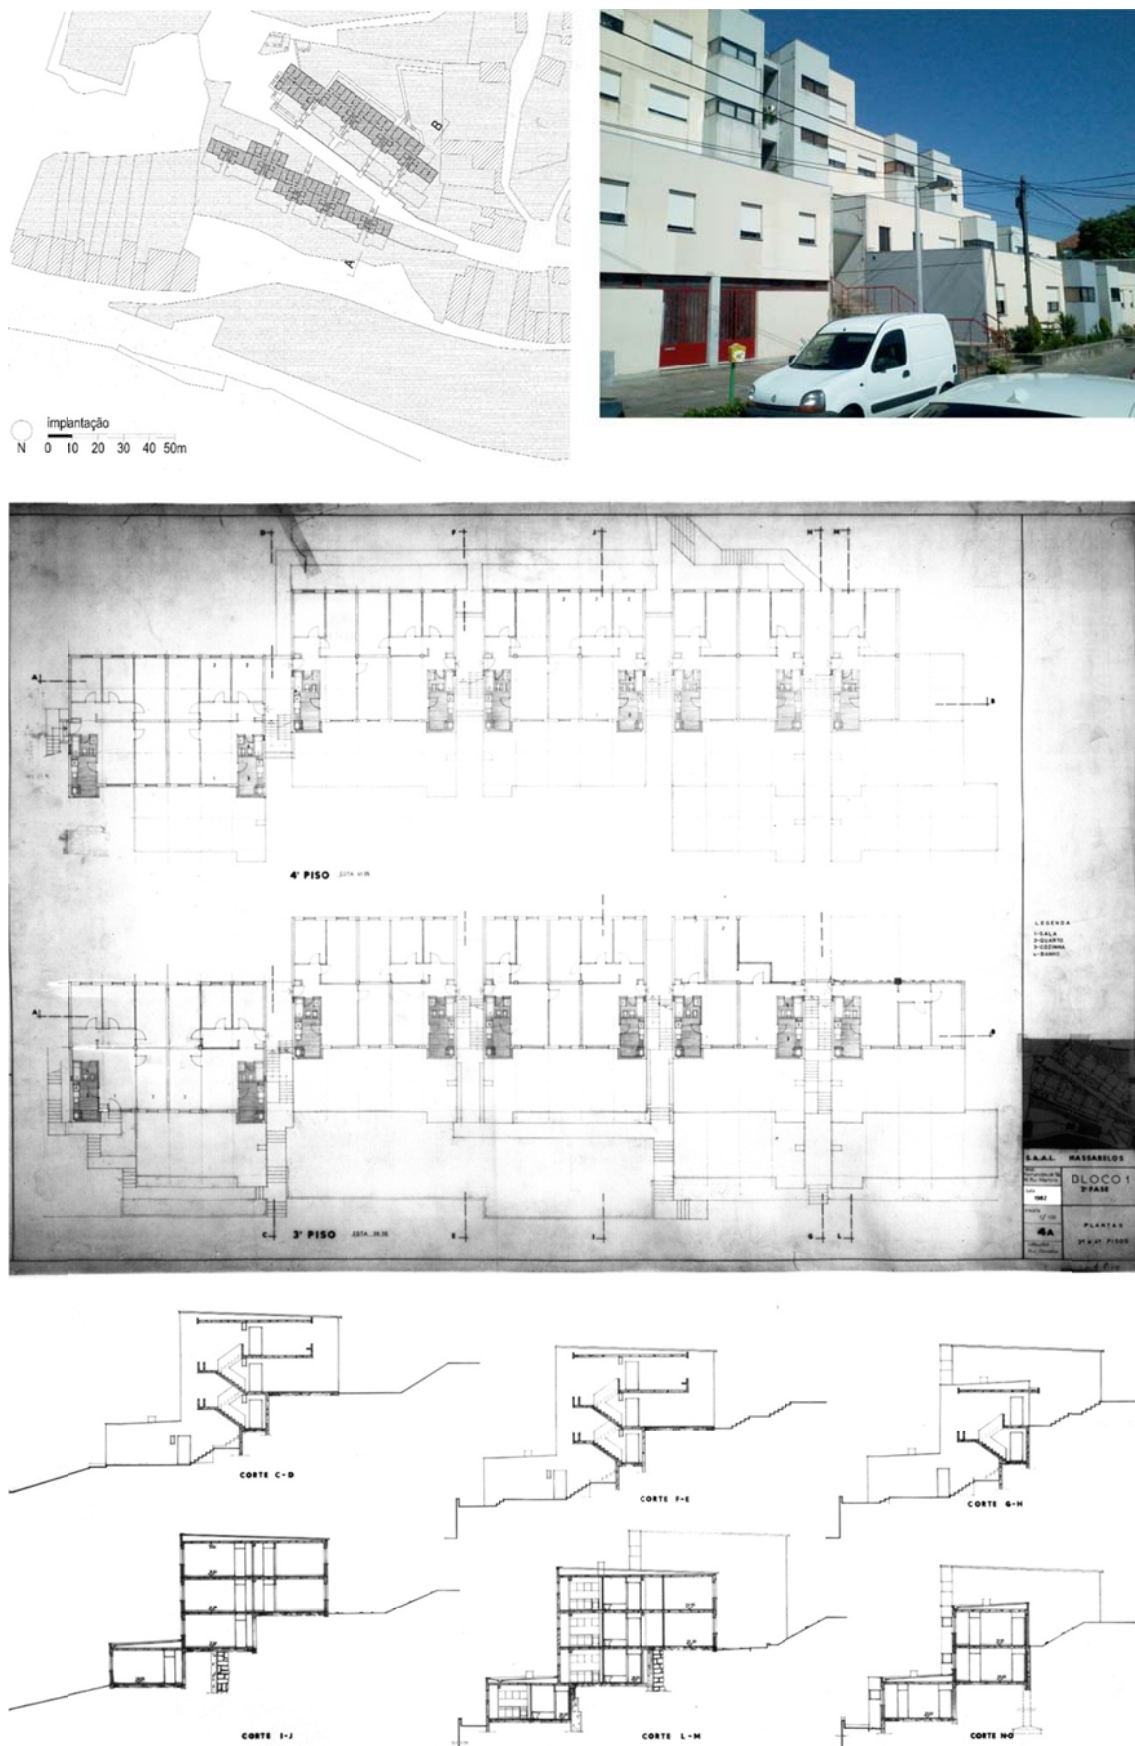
a) Bairro da Quinta do Bacalhau, planta de implantação, planta dos fogos e alçado (BANDEIRINHA, J. A., O Processo SAAL..., pág. 375).
